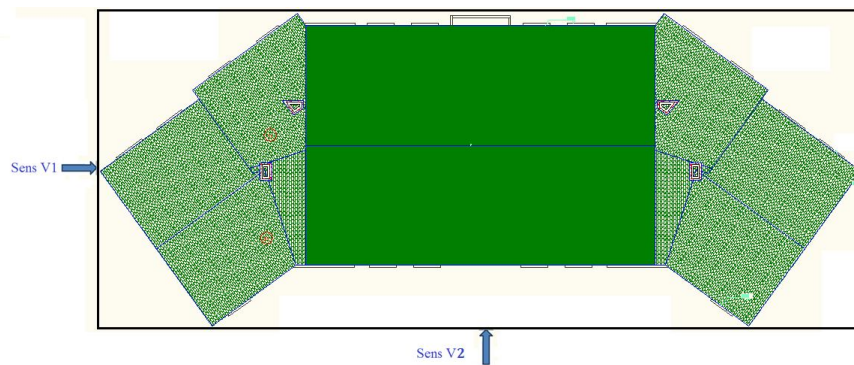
Vue en plan présenter la direction V1 et V2.
